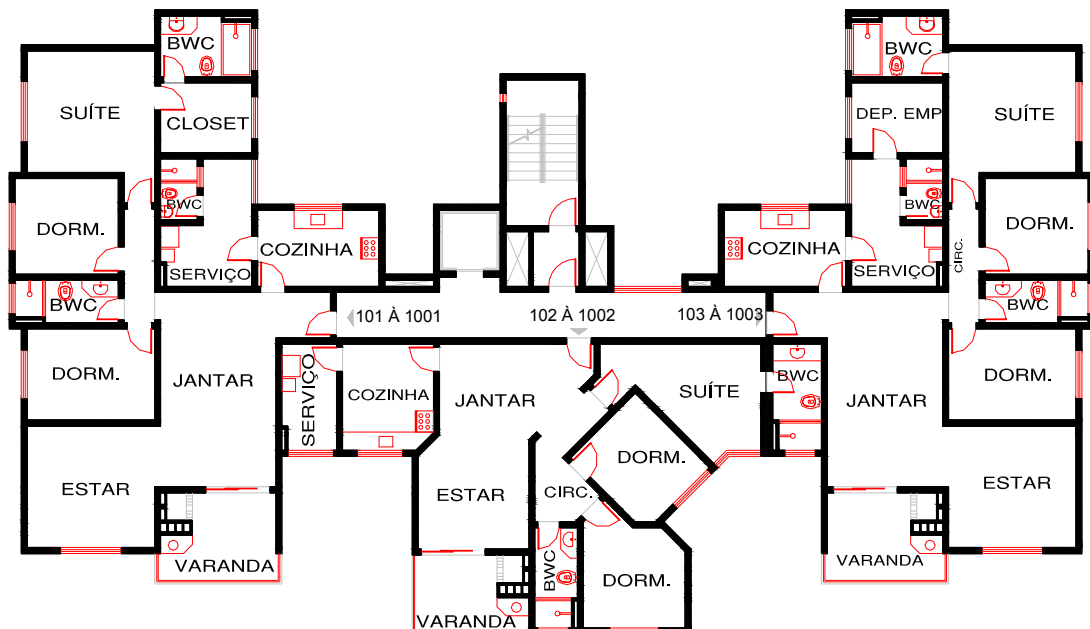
Planta Baixa do pavimento tipo do Estudo de caso A.
